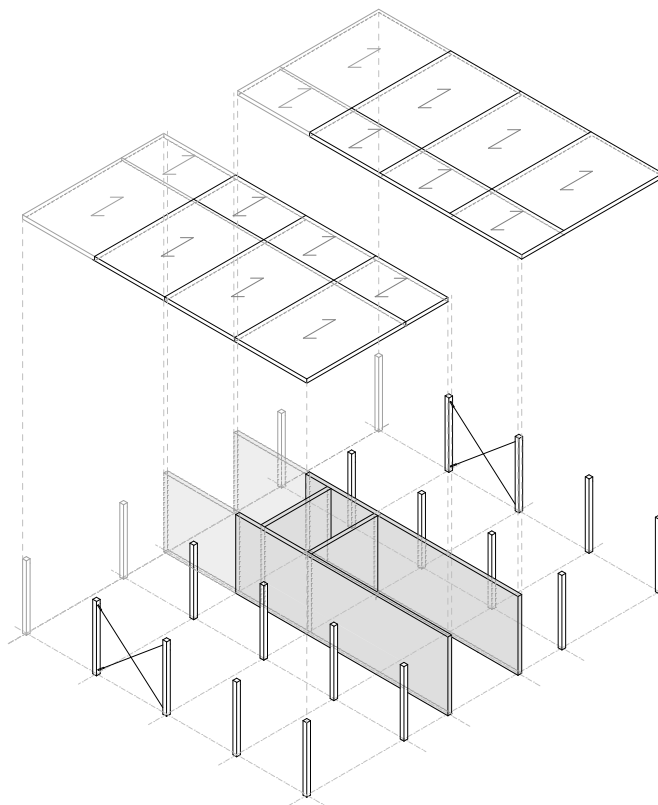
Holzskelettbau mit aussteifenden Betonkern (eigene Darstellung)
